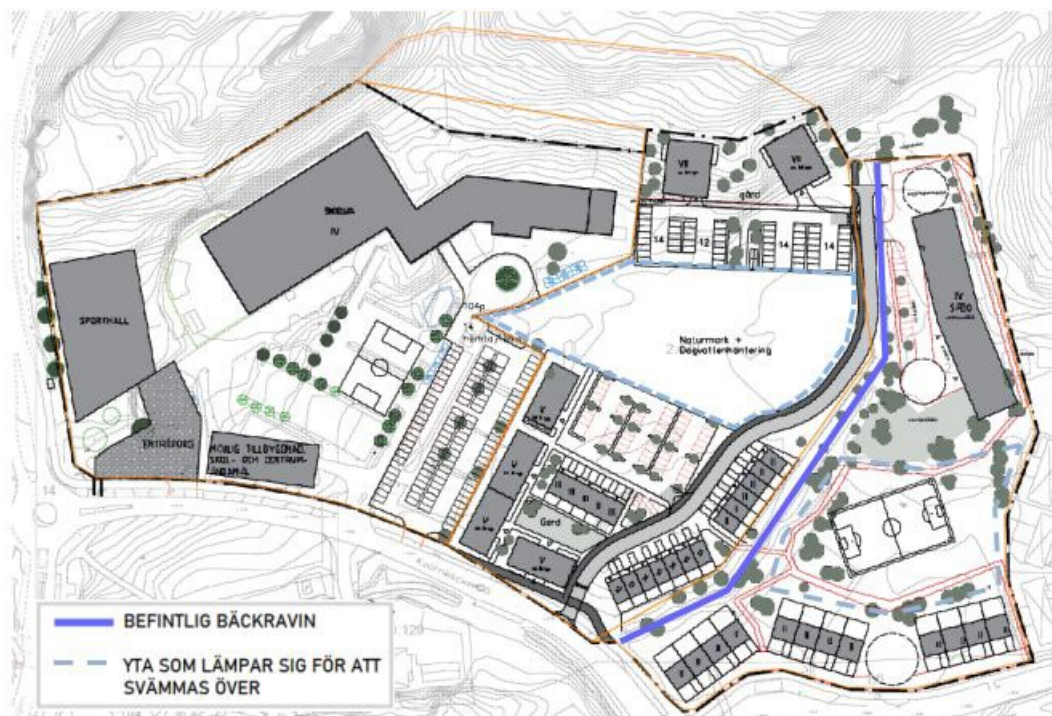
Planillustration med passande skyfallsstör inom blåstreckade linjer.
